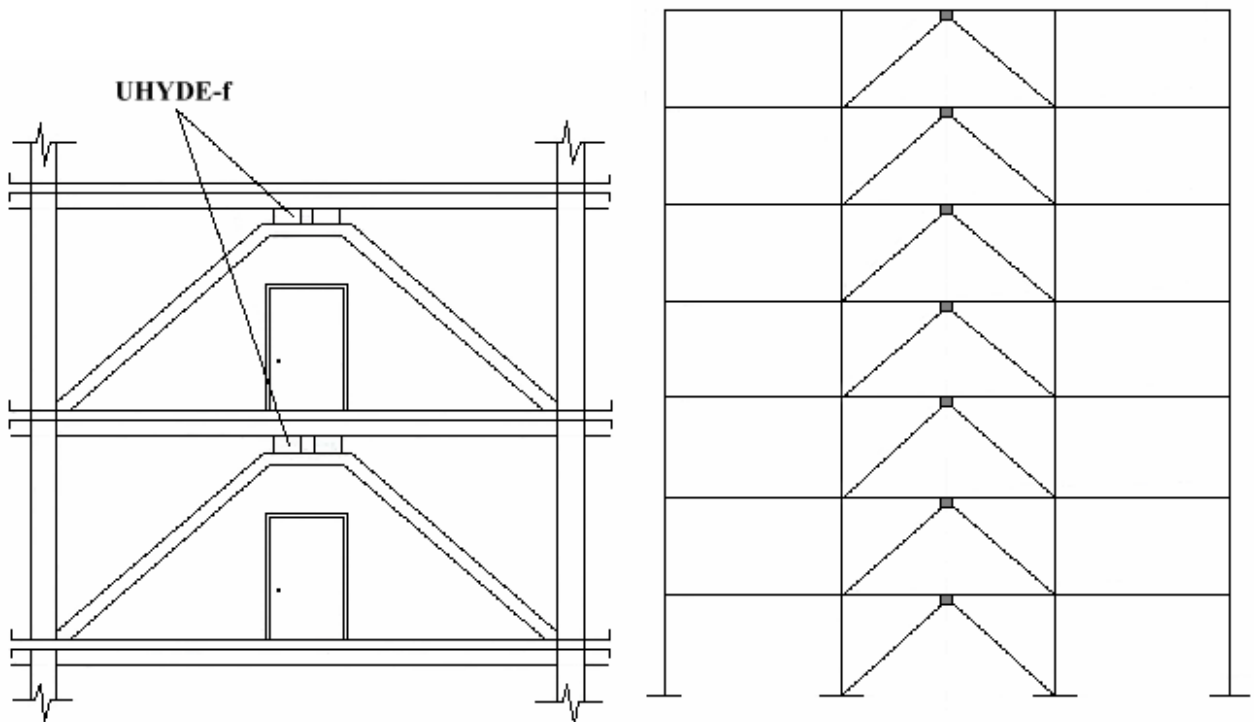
UHYDE-fs sobre un arriostramiento de acero construido dentro de un muro divisorio de un marco de hormigón armado de varios pisos.
